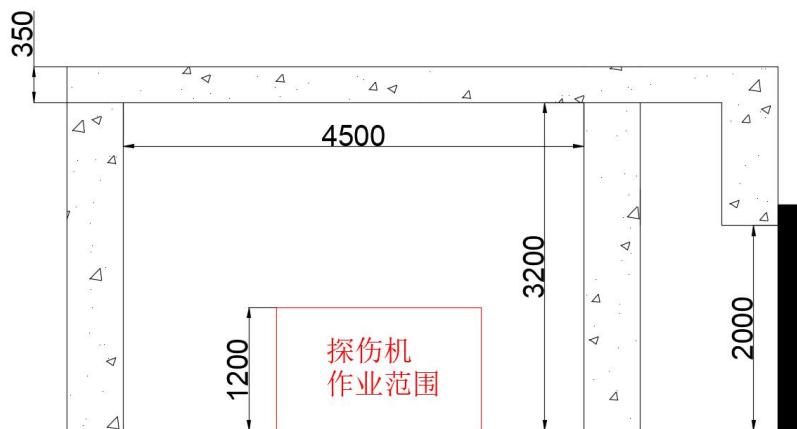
(b) 探伤机探伤作业范围 1-1 剖面图 (mm)
